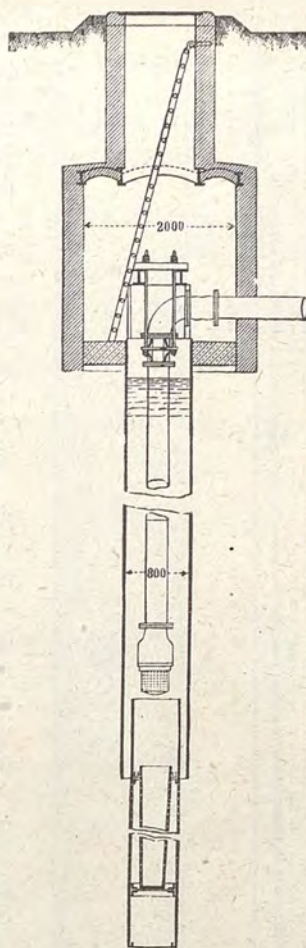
Pozzi tubolari in ferro impiantati in Mannheim (Sezione e pianta).
